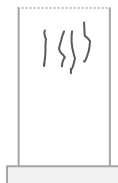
Esquema de fissura: fissura de compressió.
